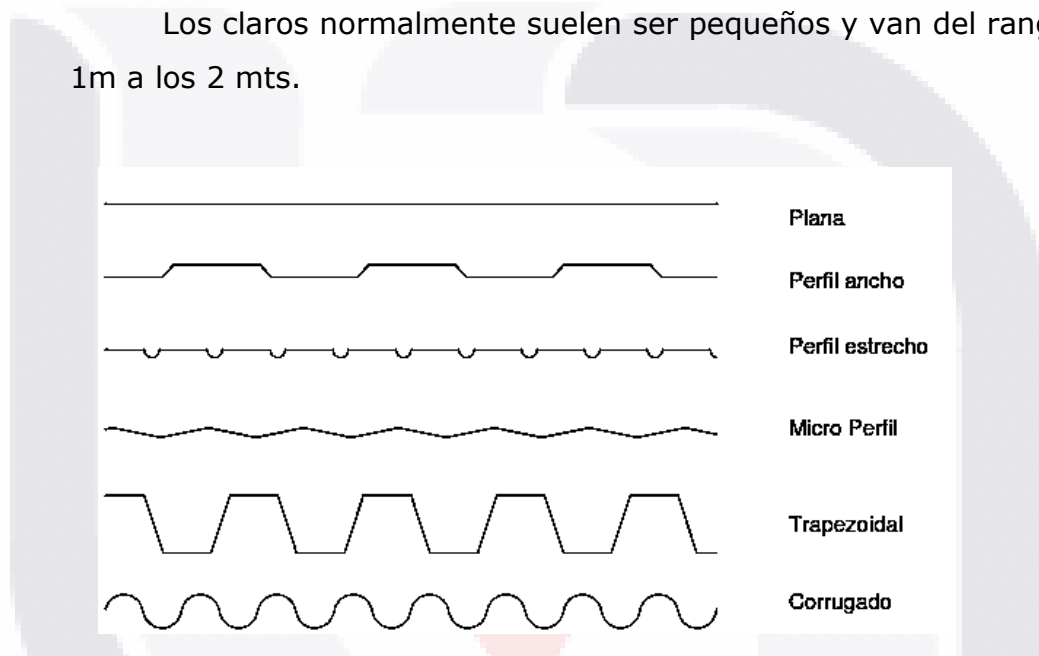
perfiles más habituales para cubiertas y fachadas (Romo Proaño n.d.).
